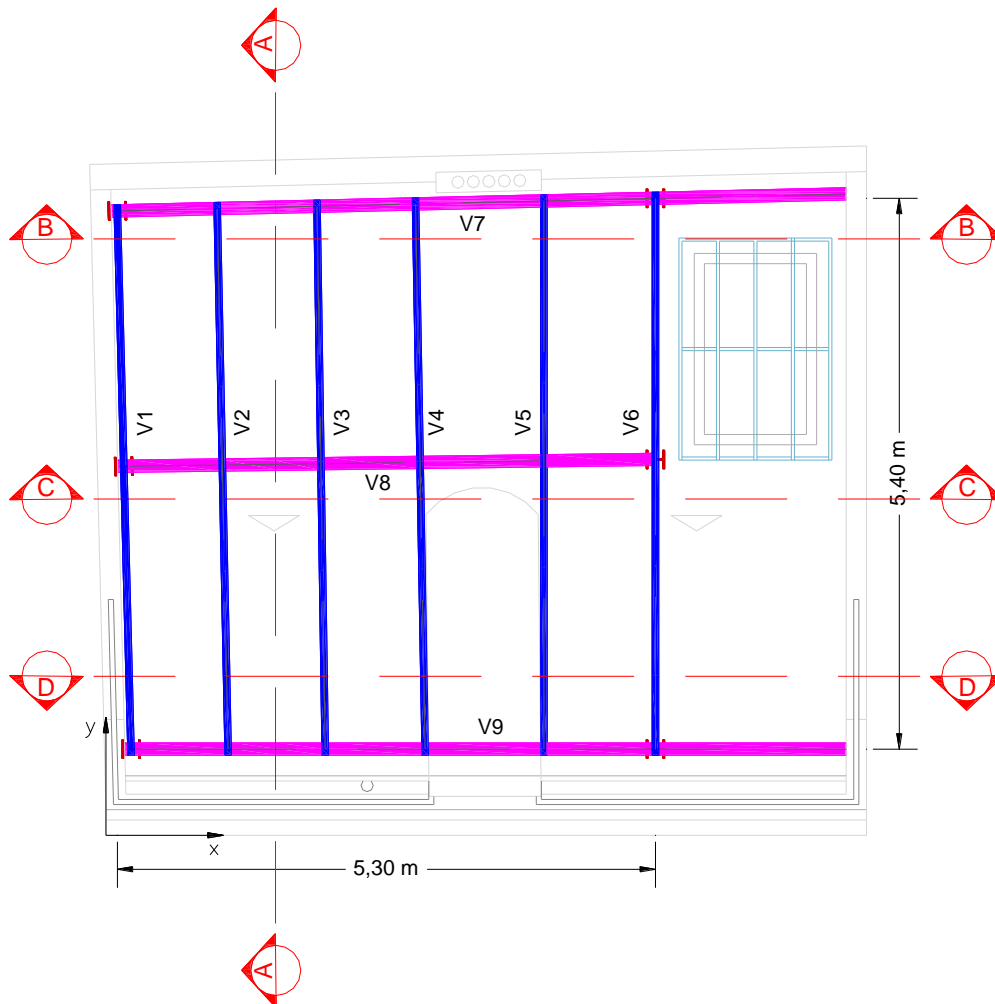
Planta da cobertura com a introdução de uma viga intermédia
